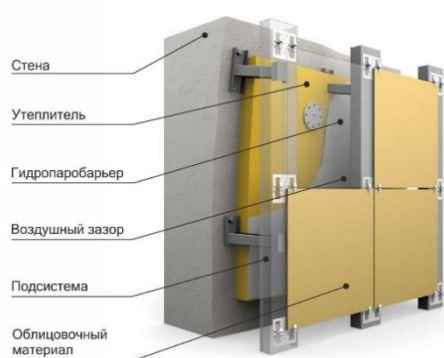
Система навесной вентилируемый фасад (НВФ).
